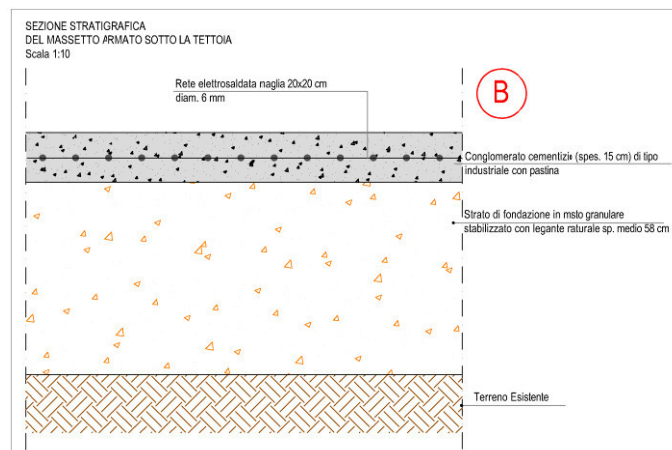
sezione stratigrafica della pavimentazione in cls sotto tettoia
